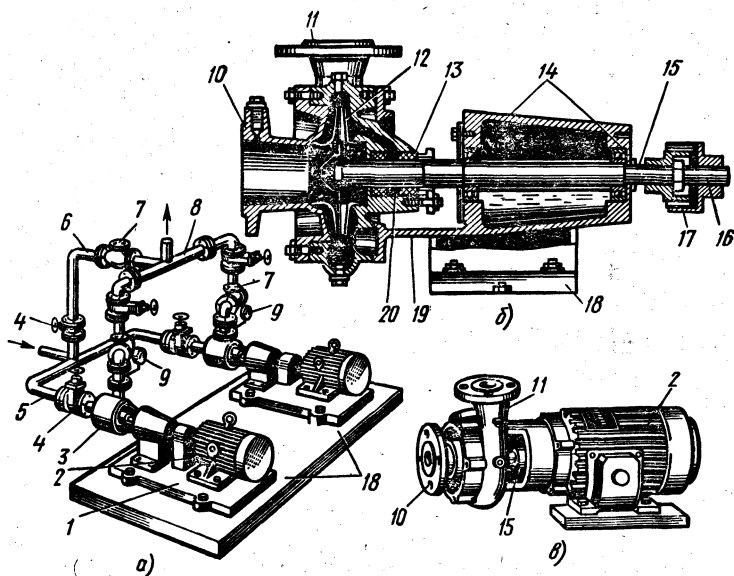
Установка для повышения давления (а); консольный (б) и моноблочный (в) насосы:
